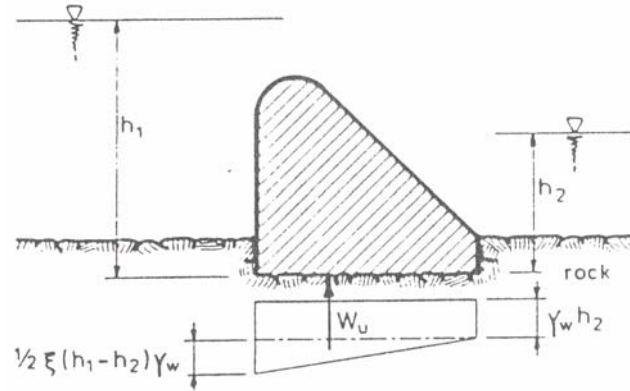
Subpresión en estructuras sobre fundación de roca
